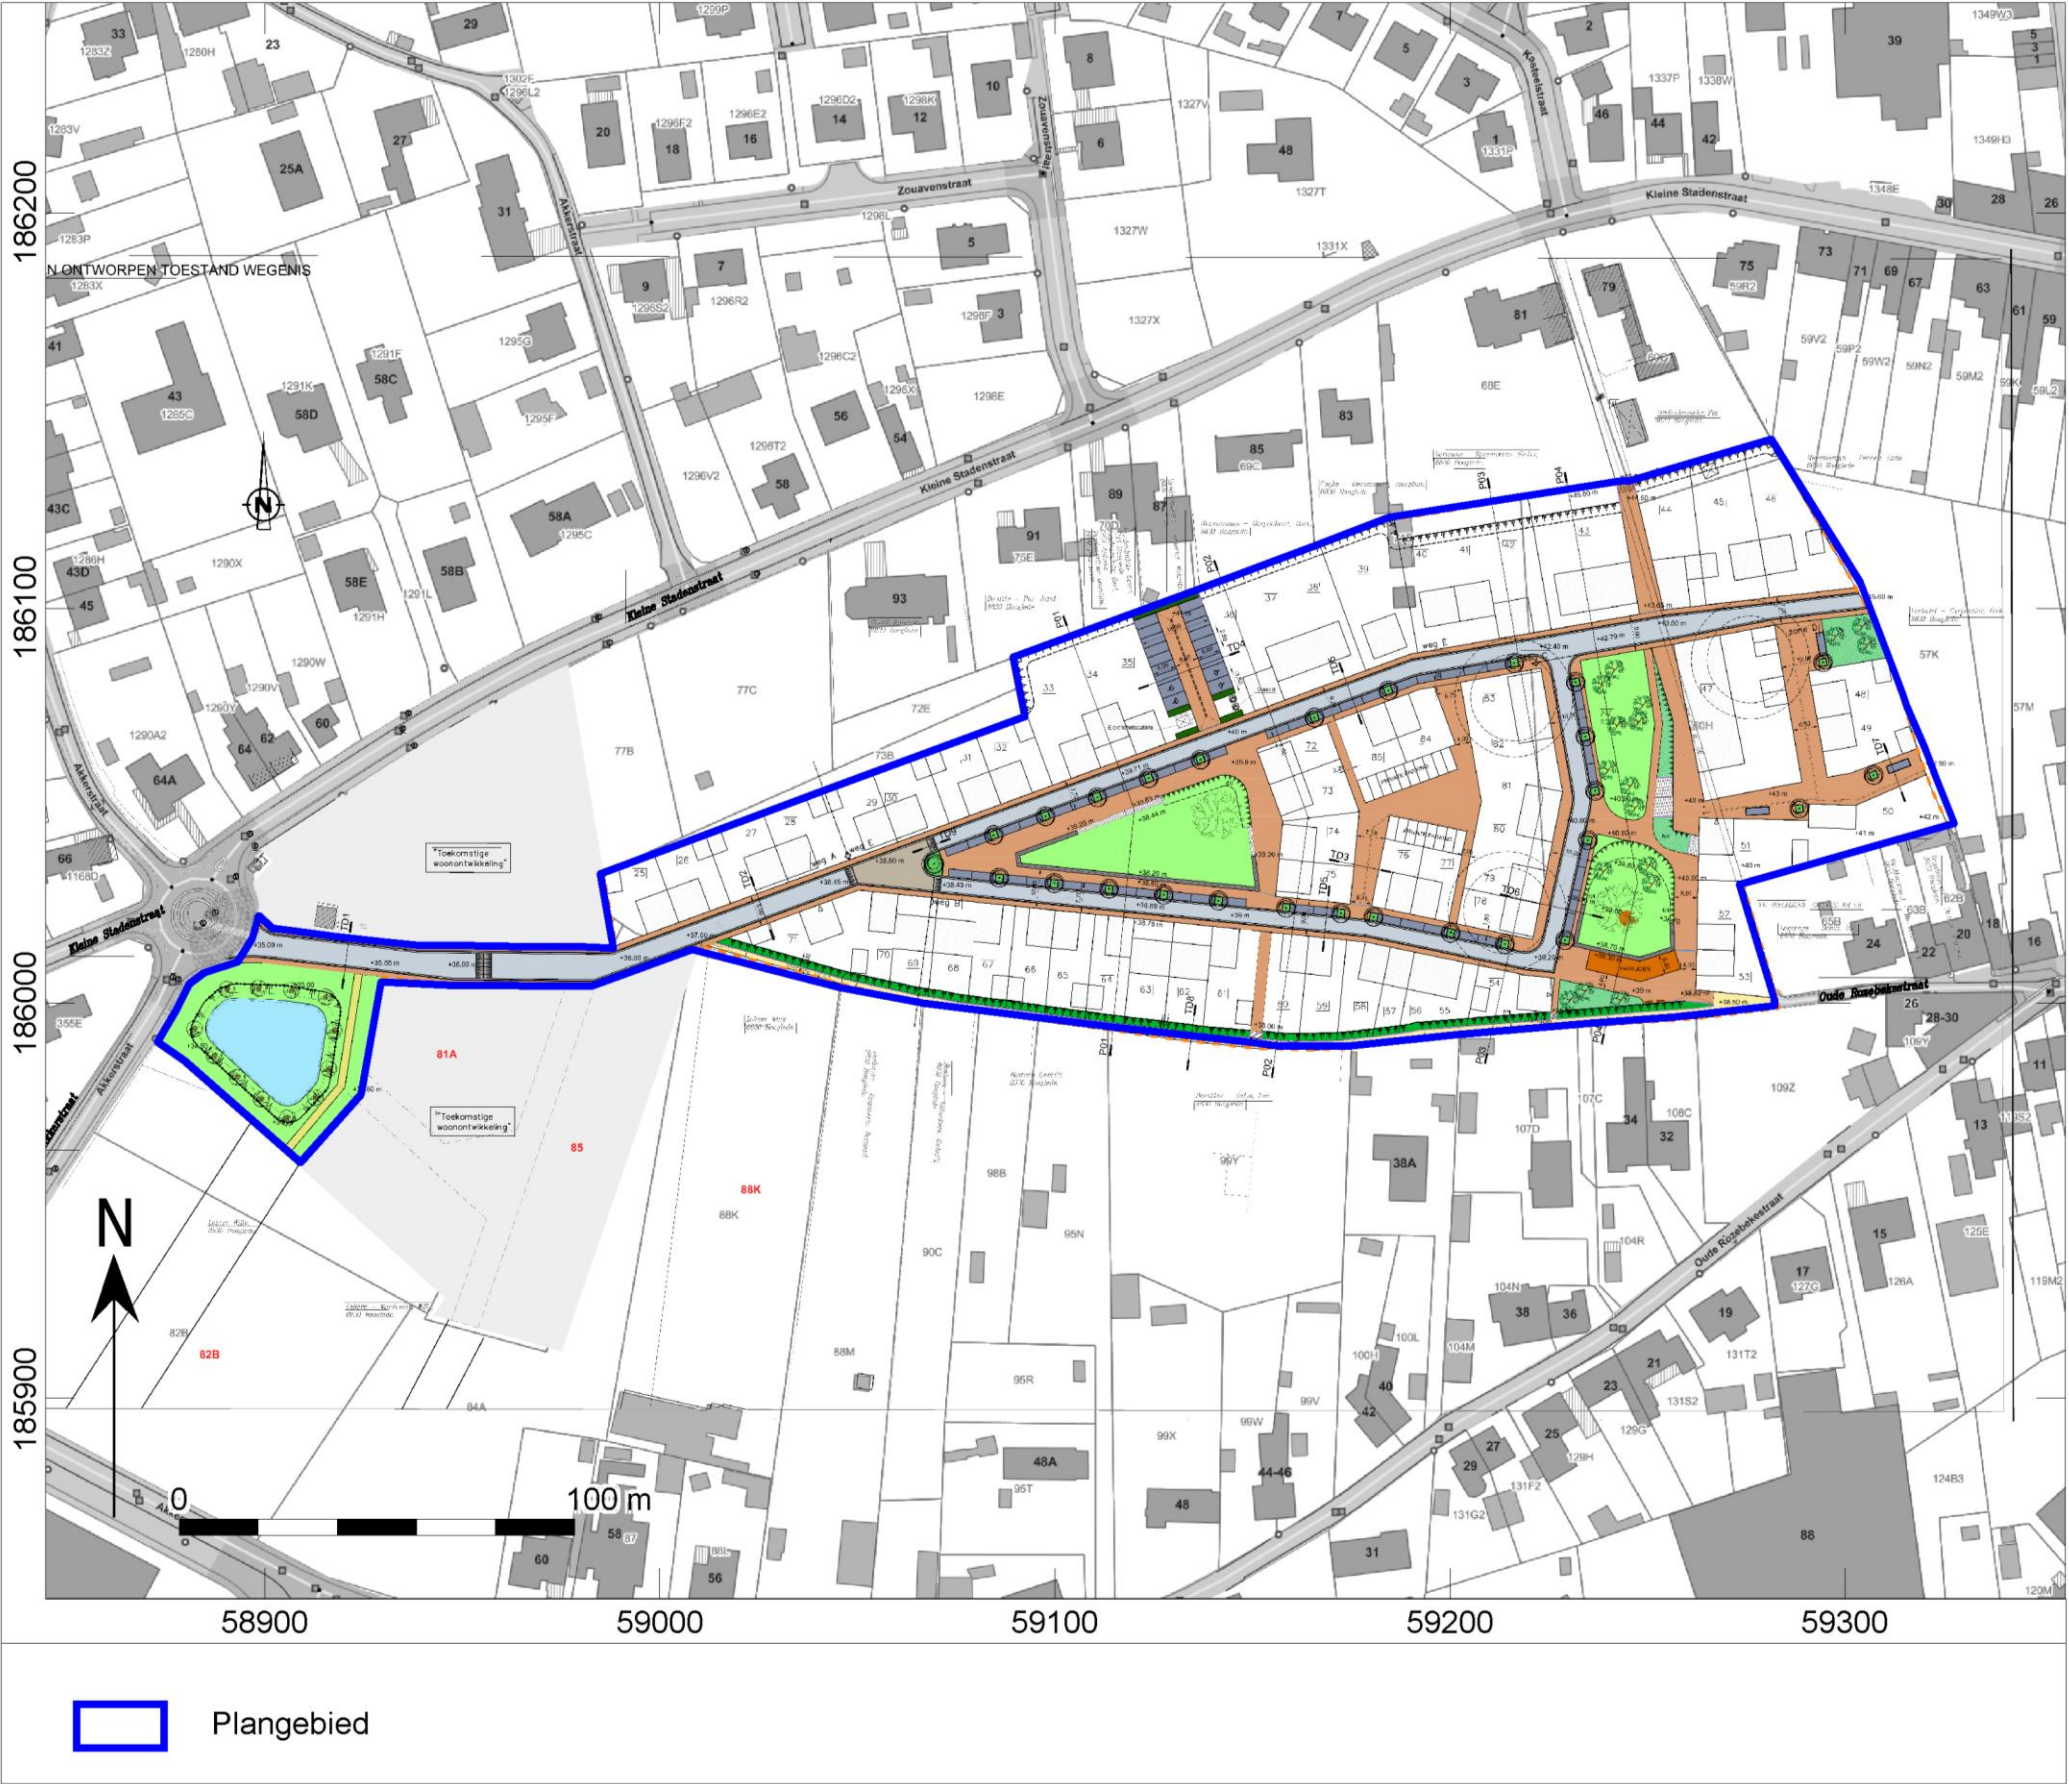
Grondplan van de nieuwe toestand van de riolering binnen het plangebied. (Bron grondplan: opdrachtgever)
